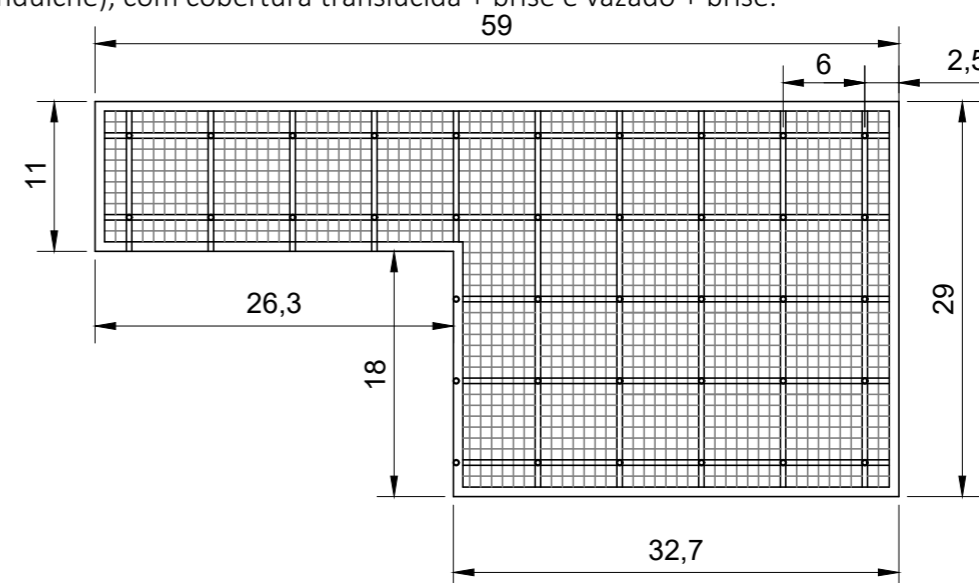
Esquema estrutural (posição dos pilares, vigas e modulação da laje nervurada) do edifício da UFFS.
